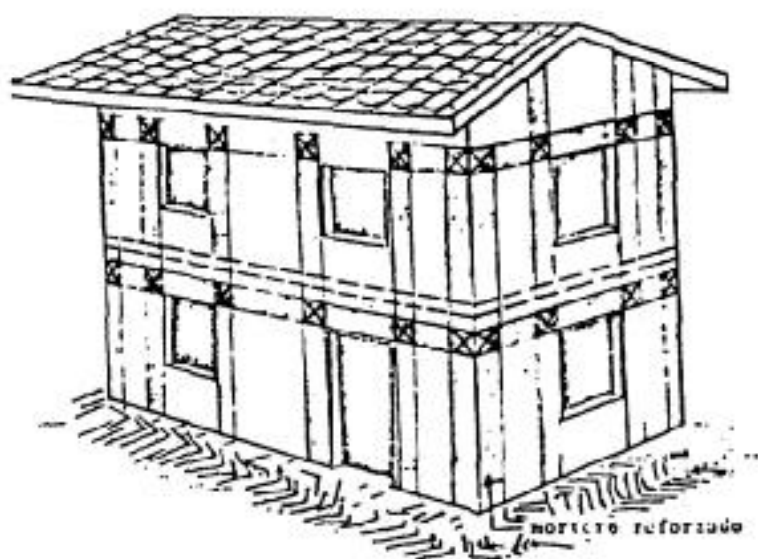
Confinamiento de muros de mampostería con fajas de mortero reforzado (ref. 9)
